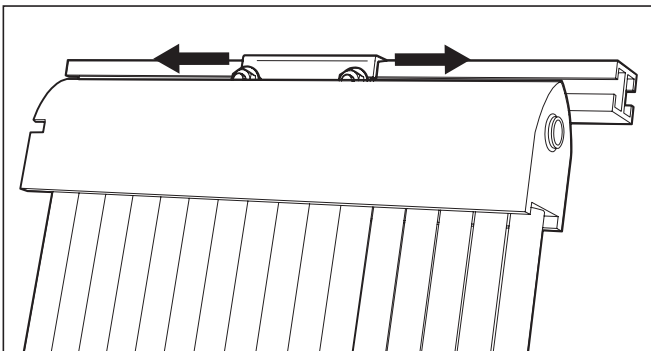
Schrauben am Befestigungswinkel lösen
